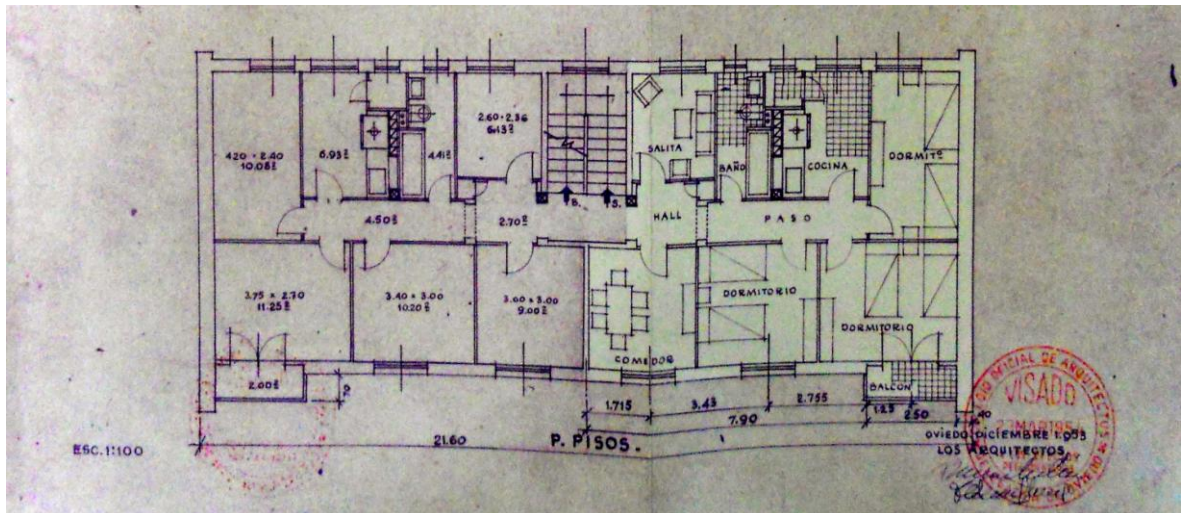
Planta de piso, viviendas para Minas Figaredo S.A., 1954 (Peñule); fotografía procedente del Archivo Municipal de Mieres
